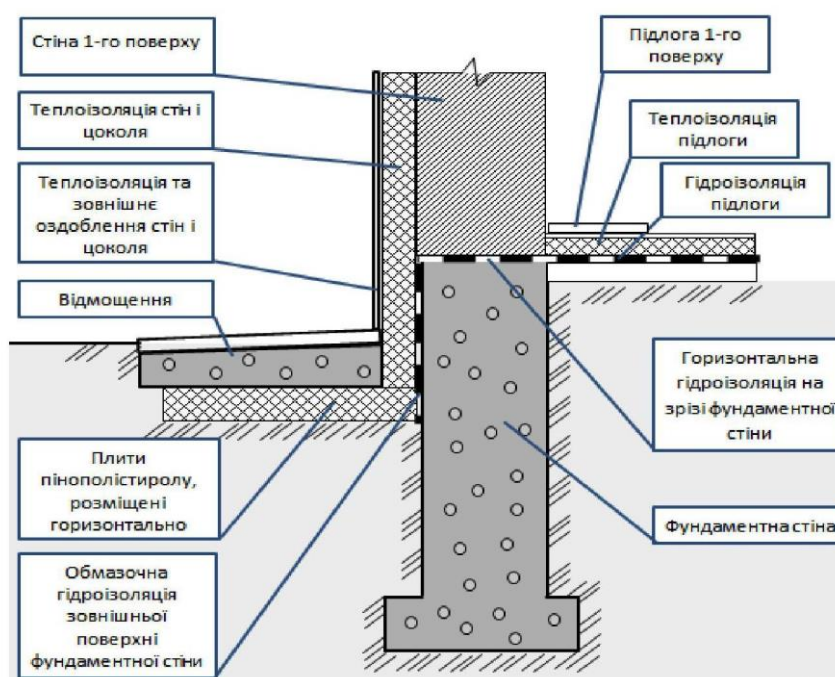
Утеплення фундаменту плитами полістиролу, які розміщені горизонтально впритиск до зовнішньої поверхні фундаментної стіни [6]
